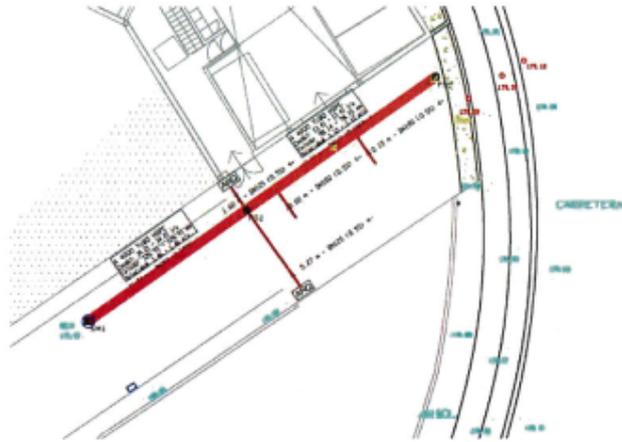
Red de alcantarillado (Fuente: Proyecto Acceso Urbanización Calle Claudio F. Sarmiento, Plano N° 10).
